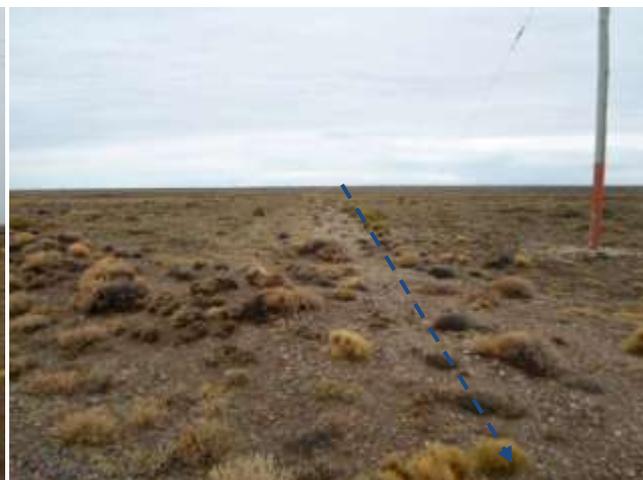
Emplazamiento por picada existente. Foto en dirección S.
